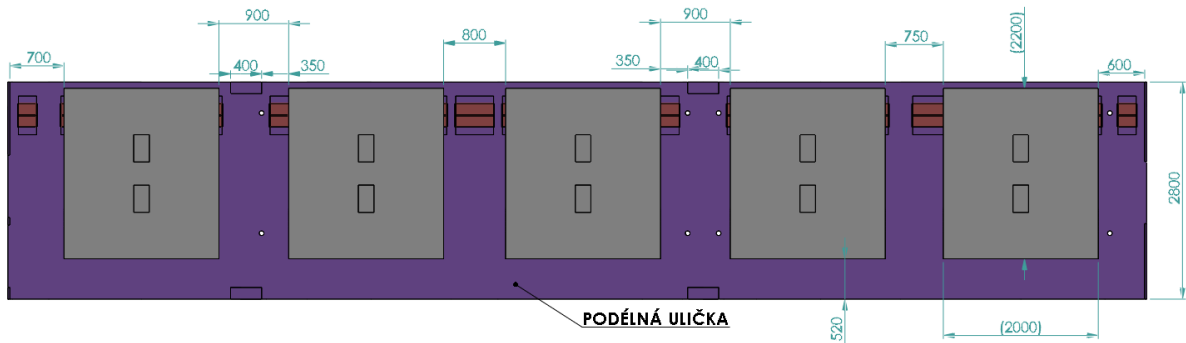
Definitivní stavební struktura - detail zahloubení pro kola
